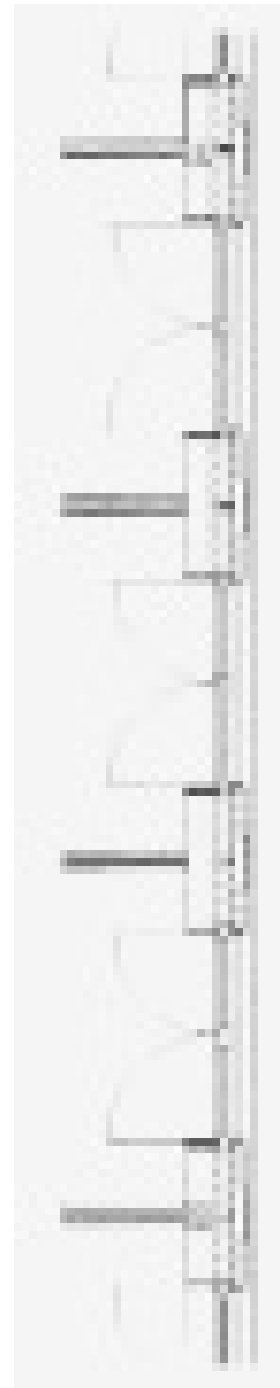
Darstellung eines Kollhoff-typischen Wandaufbaus mit geschichteter Oberfläche (im Bild rechts)
